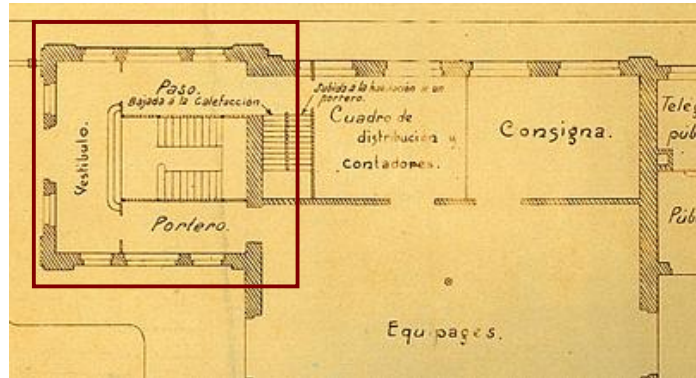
Planta. Zaguán y núcleo escaleras torreón izquierdo. (FFE- 2008).
